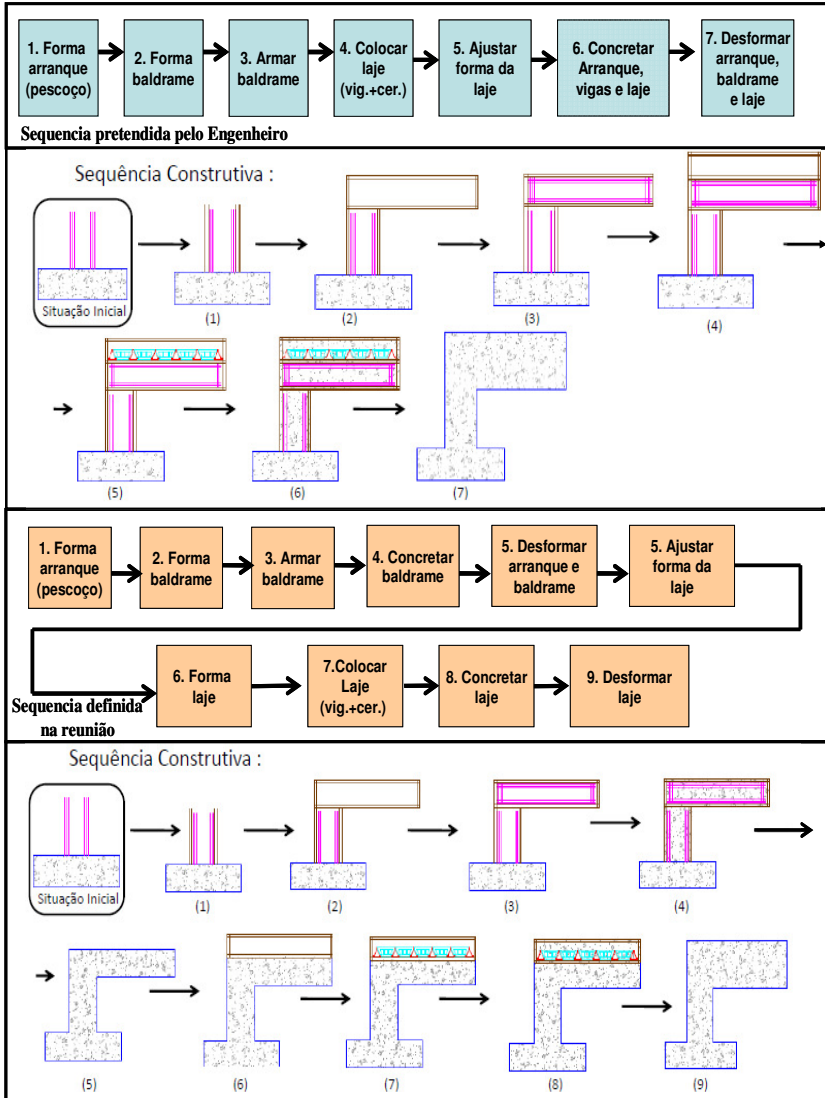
Sequências de execução das tarefas de arranque, baldrame e laje estruturada do térreo, discutidas na reunião de 22/08/2008
